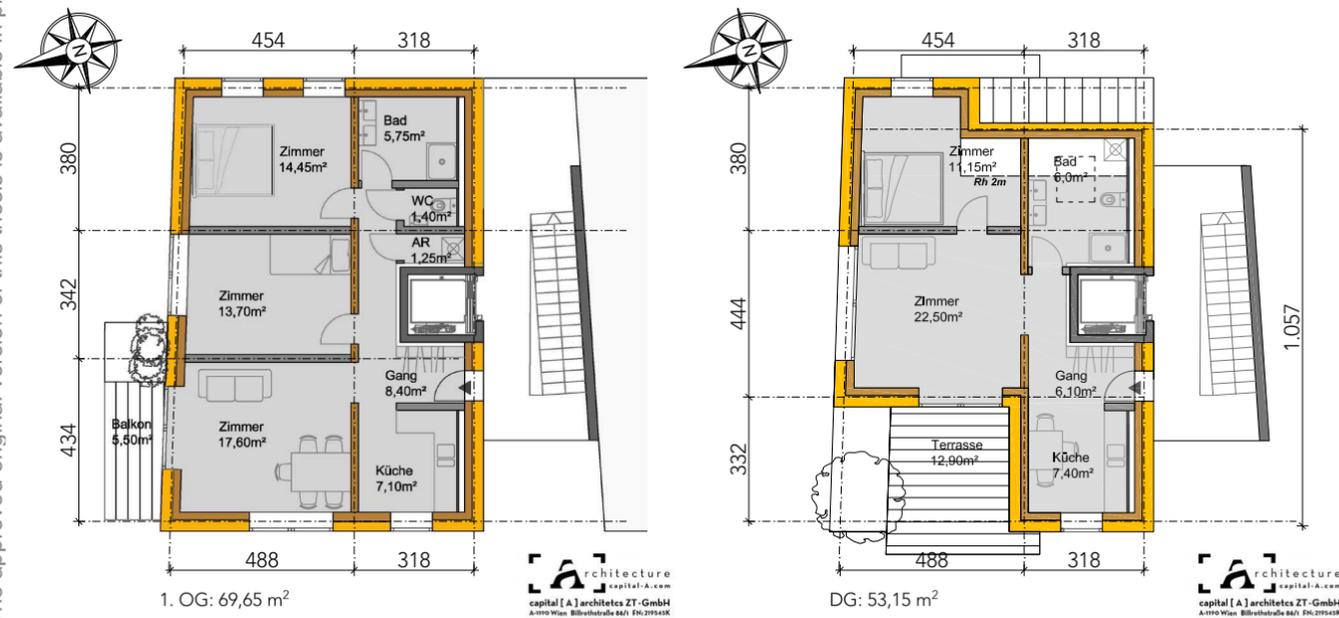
Grundrisse Obergeschoss und Dachgeschoss, Quelle: <https://www.capital-a.at/strohhaus-wien>
